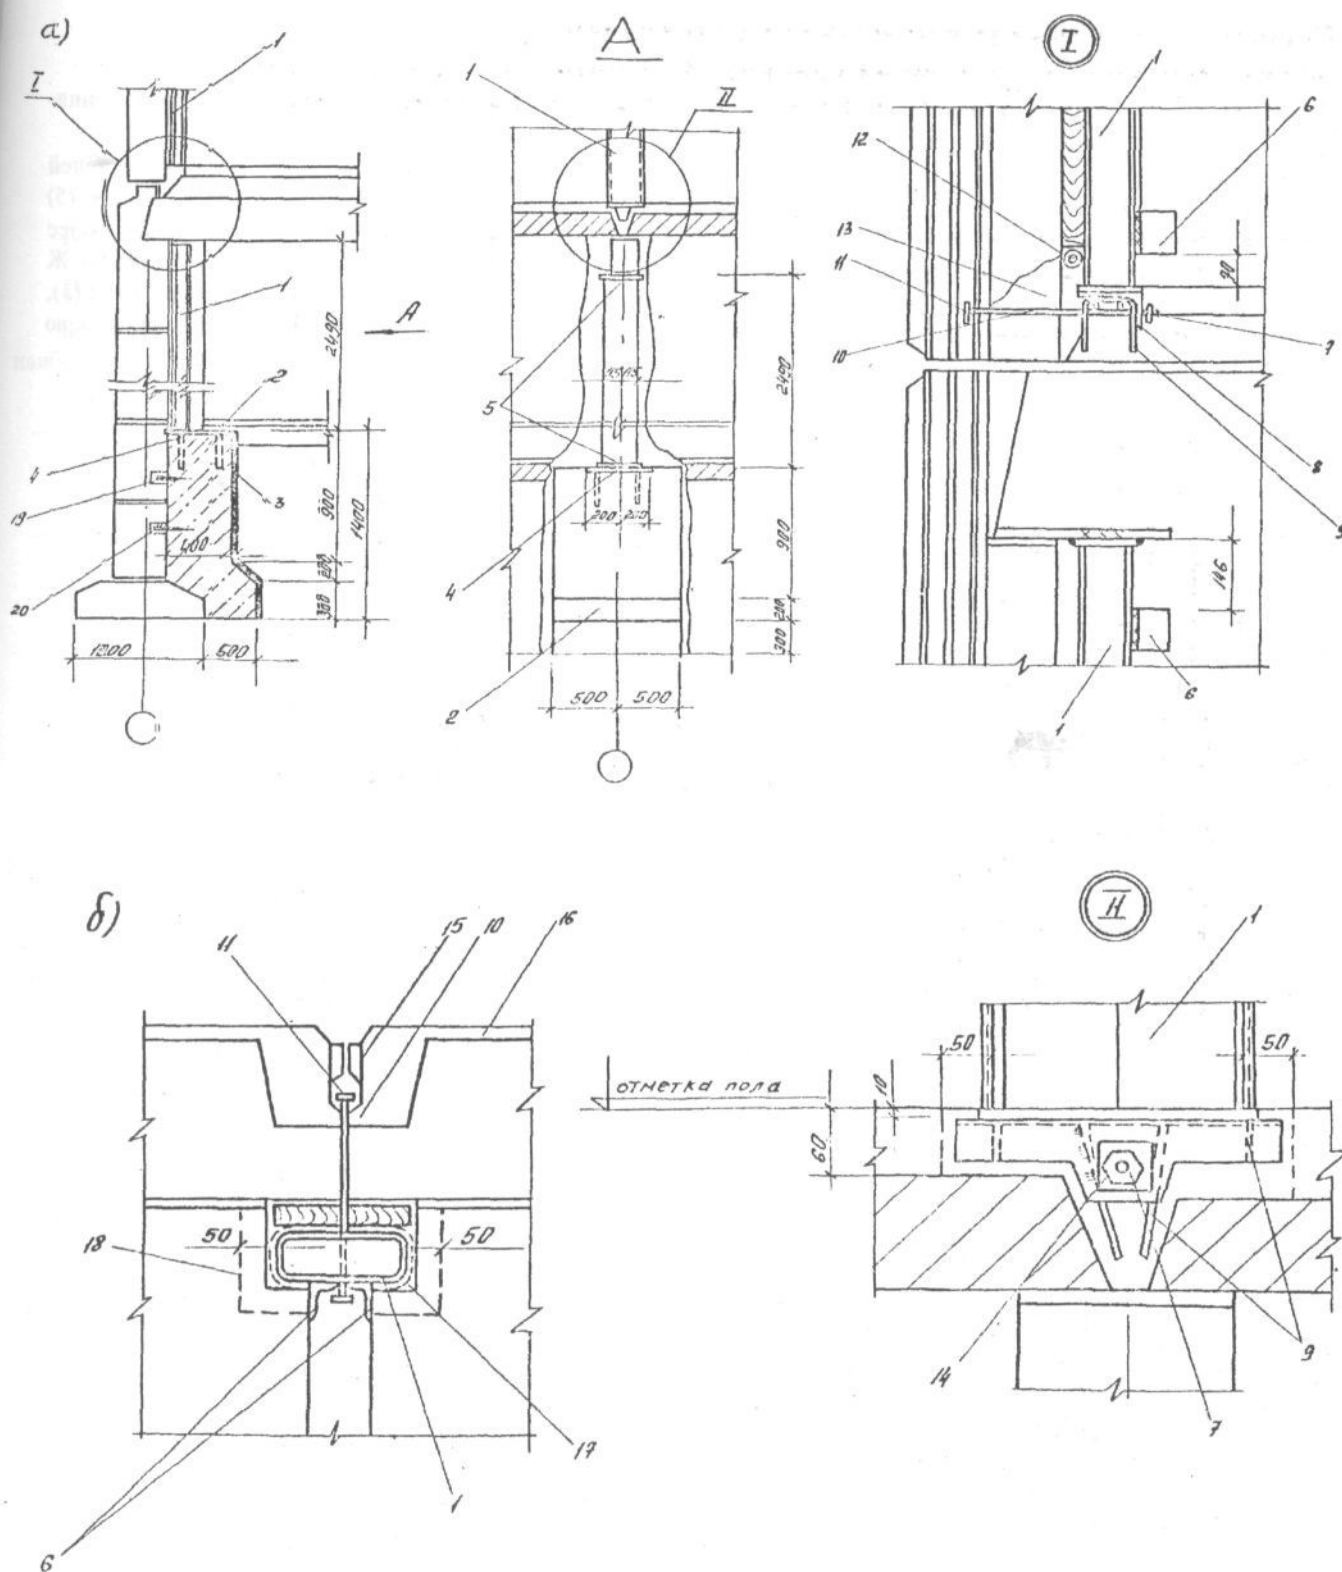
Усиление конструкции опирания прогона на наружную стену.
